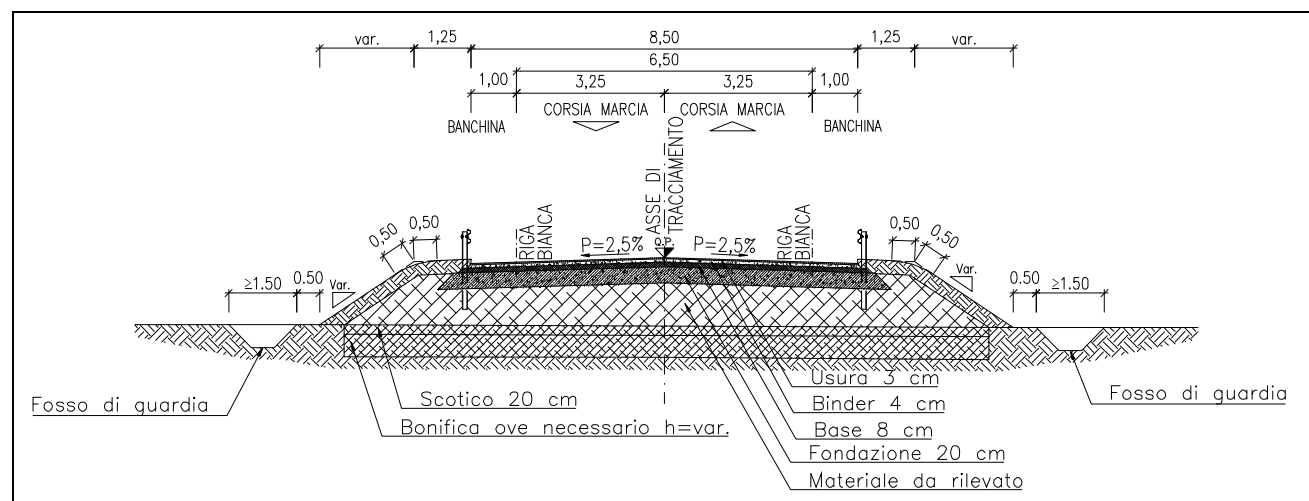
TRATTA SU NUOVA SEDE STRADALE SEZIONE TIPO "F2 EXTRAURBANA" IN RILEVATO IN RETTIFILO
